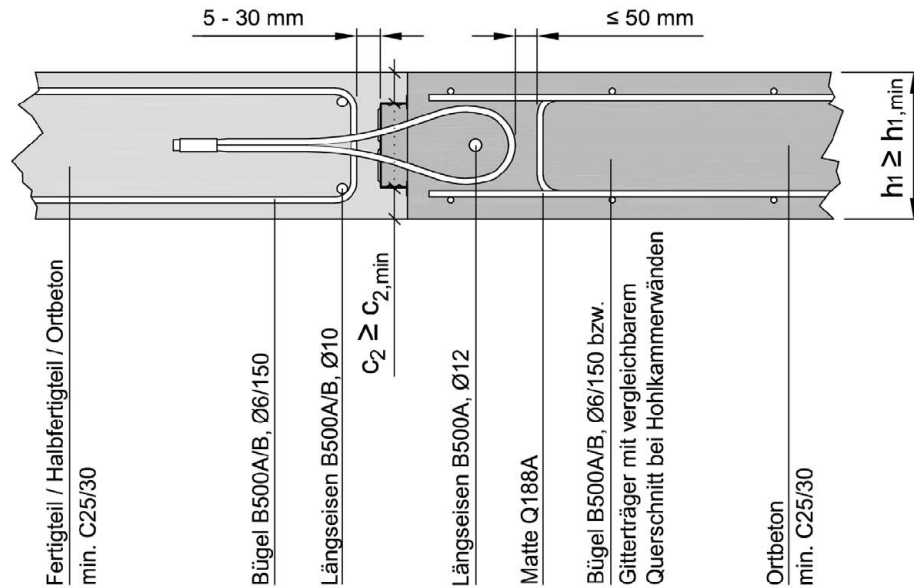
Regel-Querschnitt mit Ortbetonergänzung, Bewehrung
